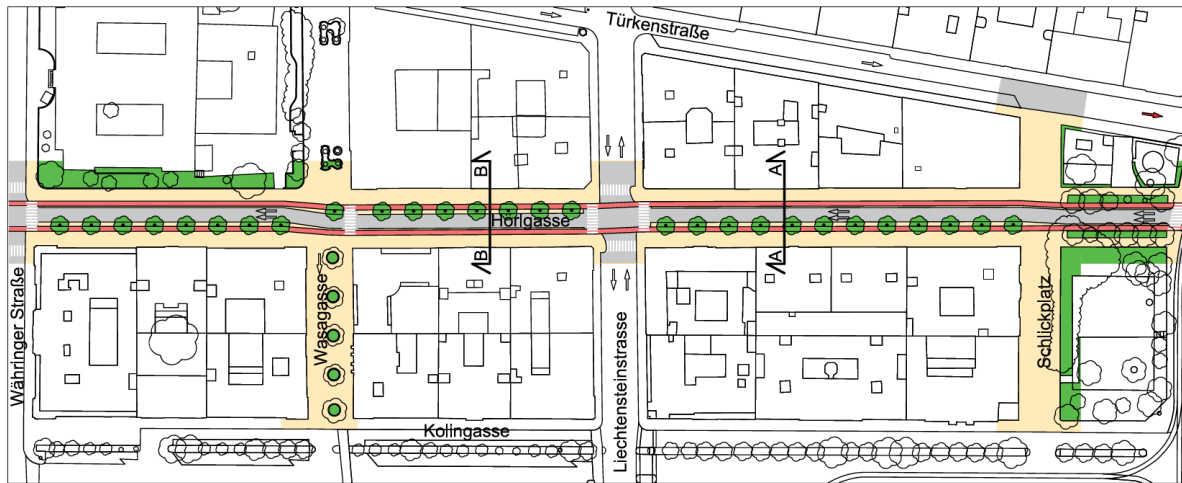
Grundriss Variante 2 (2x Einrichtungsradschw)
